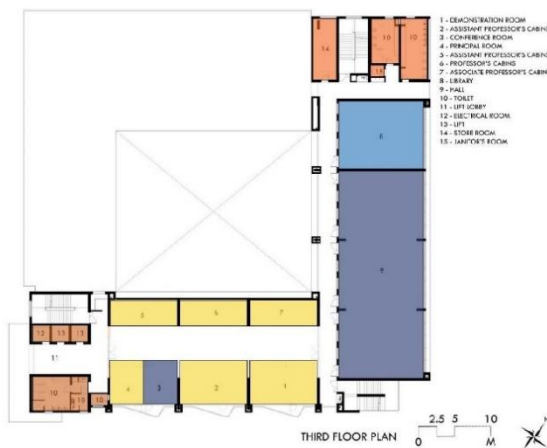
Plan du 3eme étage; Source: site du bureau, <https://www.spacematters.in/>
